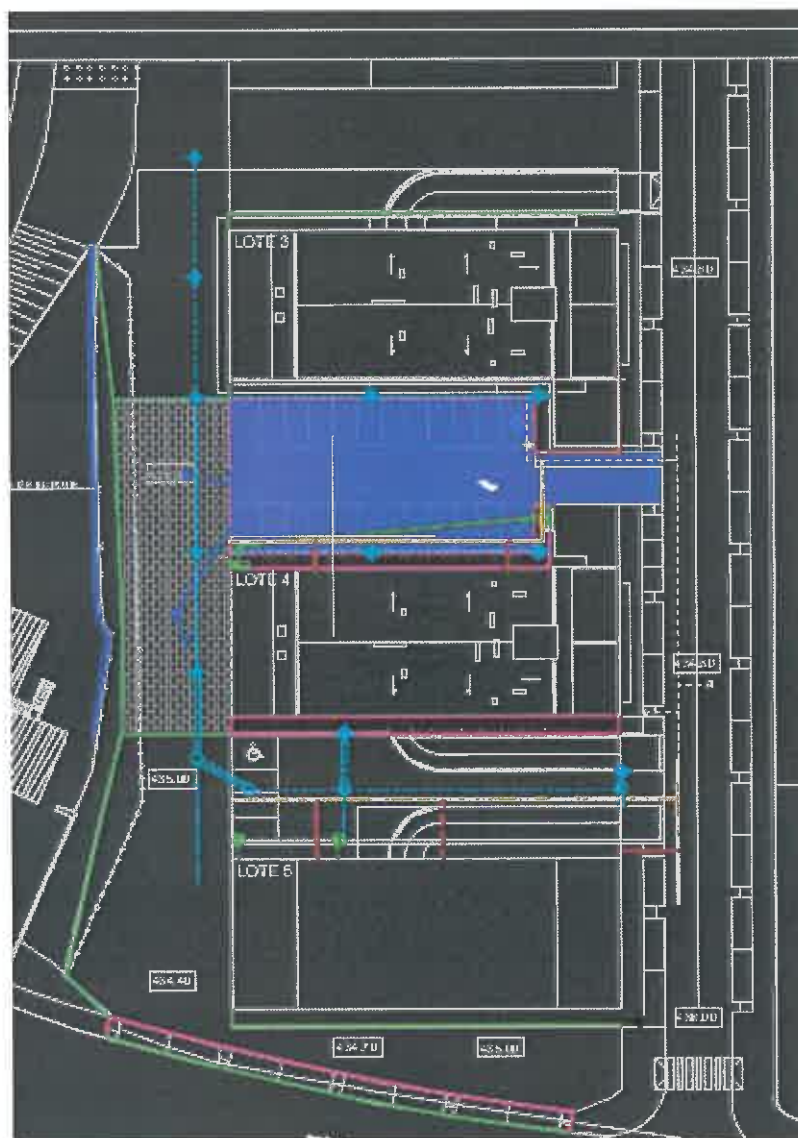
Identificação dos lotes do loteamento e da zona de intervenção
